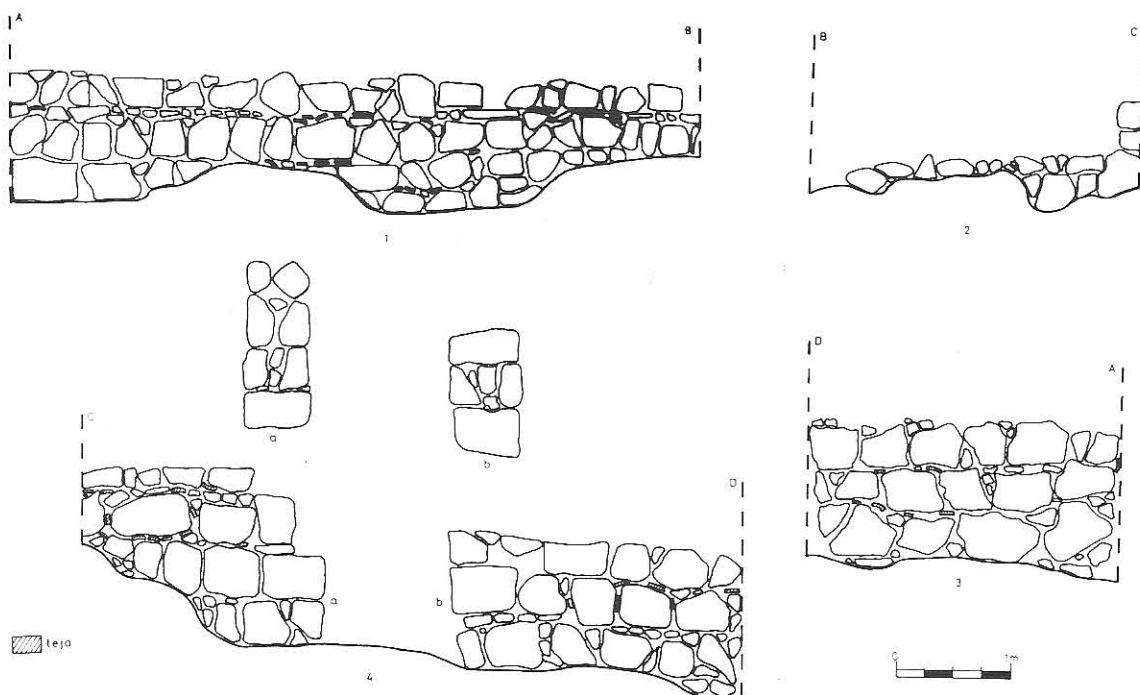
Alzados de los muros, vistos desde el interior, del sector 3. 1. Muro oeste. 2. Muro norte. 3. Muro sur. 4. Muro oeste.
